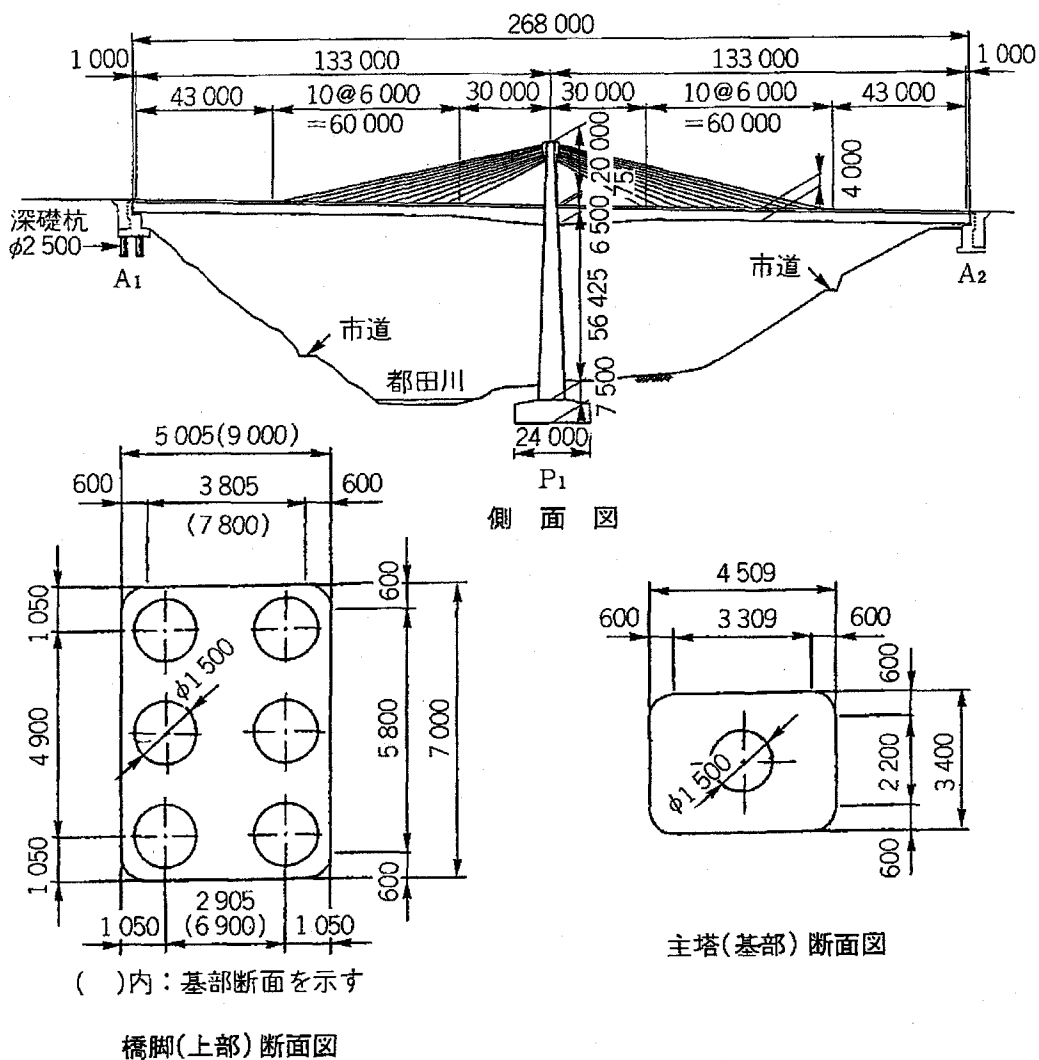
都田川橋側面図および橋脚・主塔断面図
